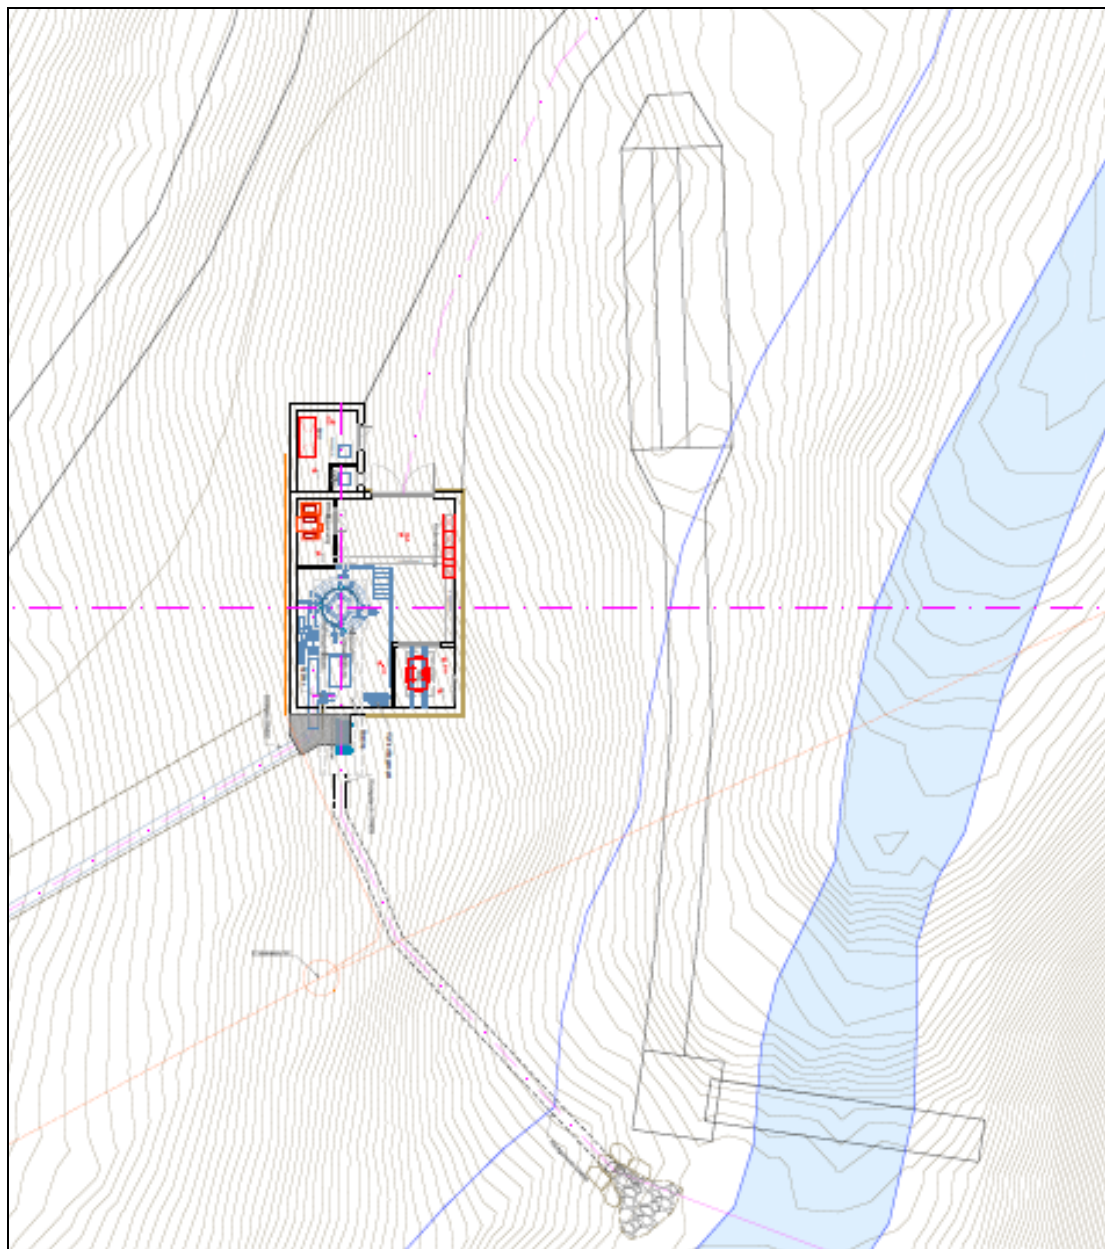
Planimetria centrale e restituzione (fonte: Tavole progettuali)
